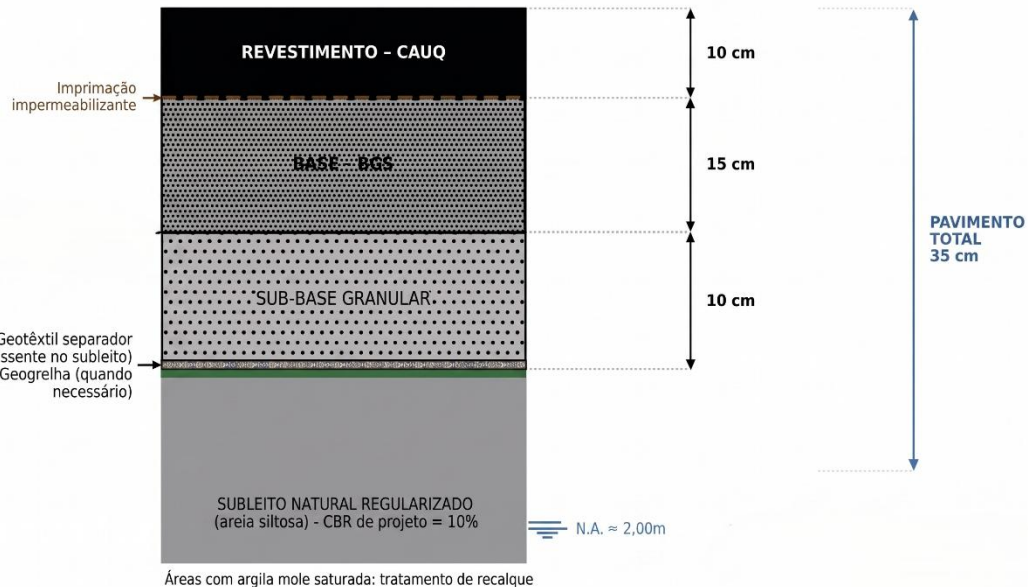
Estrutura do pavimento – Rua Dr. Reinaldo Schmithausen (fora das galerias).
